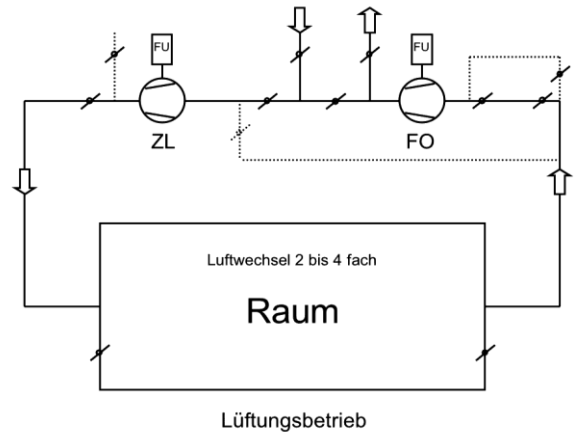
Anlagenschema einer Lüftungsanlage im Normalbetrieb
